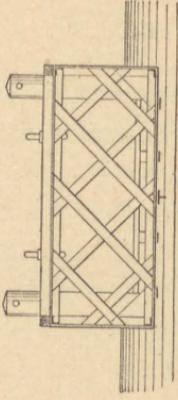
Demi-coupe horizontale (Le plancher enlevé).
